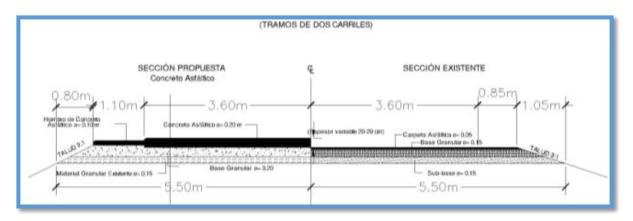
Sección Típica de Alternativa Pavimentación Con Concreto Asfáltico
